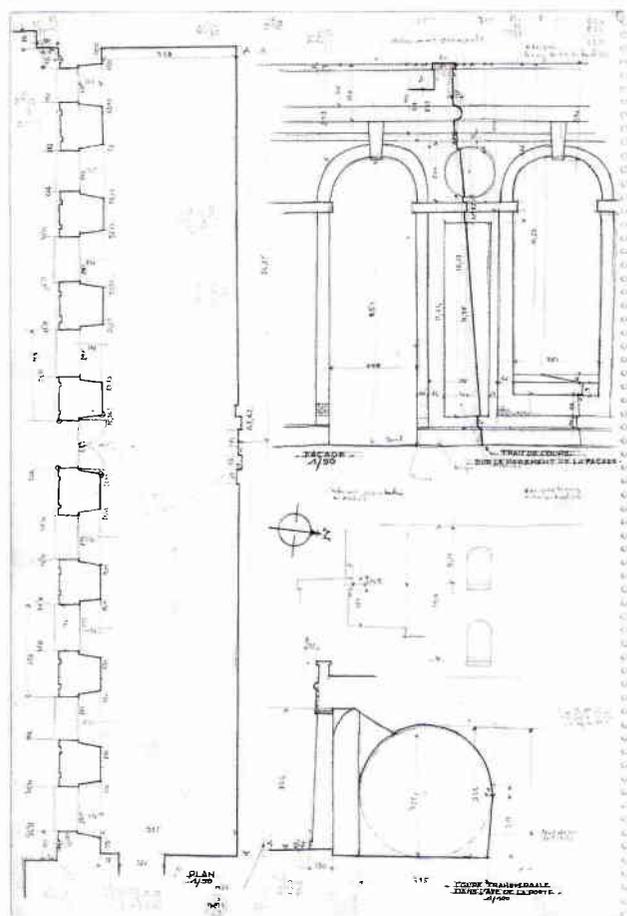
Plan, coupe et élévation de l'Orangerie (dessin de l'auteur).
